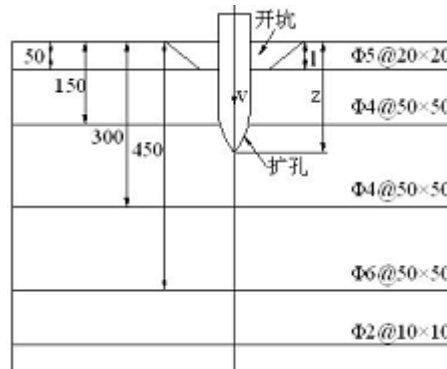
弹丸侵彻钢筋混凝土靶板瞬态示意图(mm)
